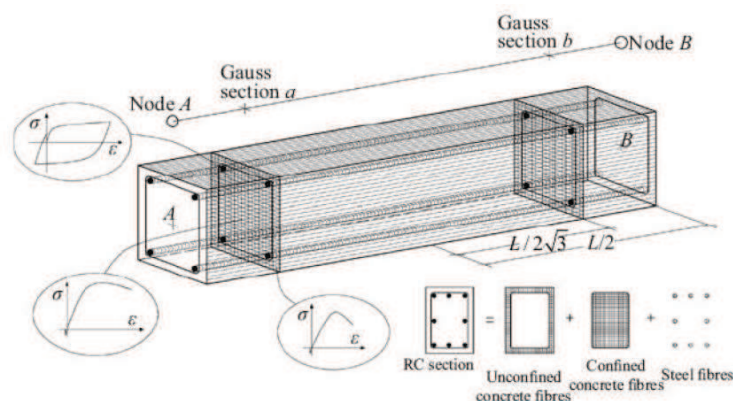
Discretização do elemento estrutural tipo de betão armado. [22]
